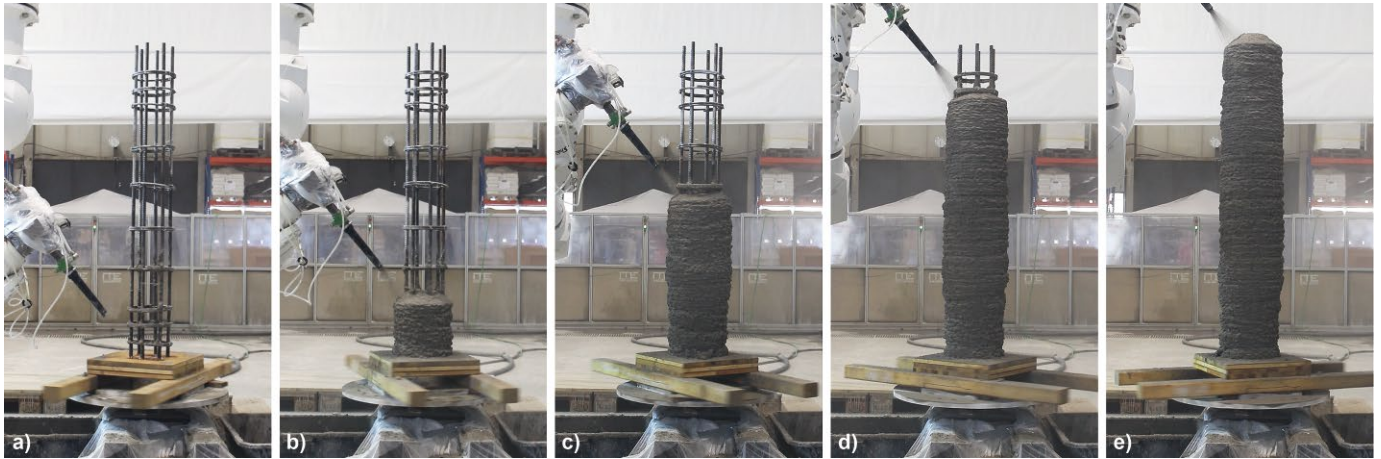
Kontinuierlicher 3-D-Betondruckprozess einer Stahlbetonstütze a) bis e)
